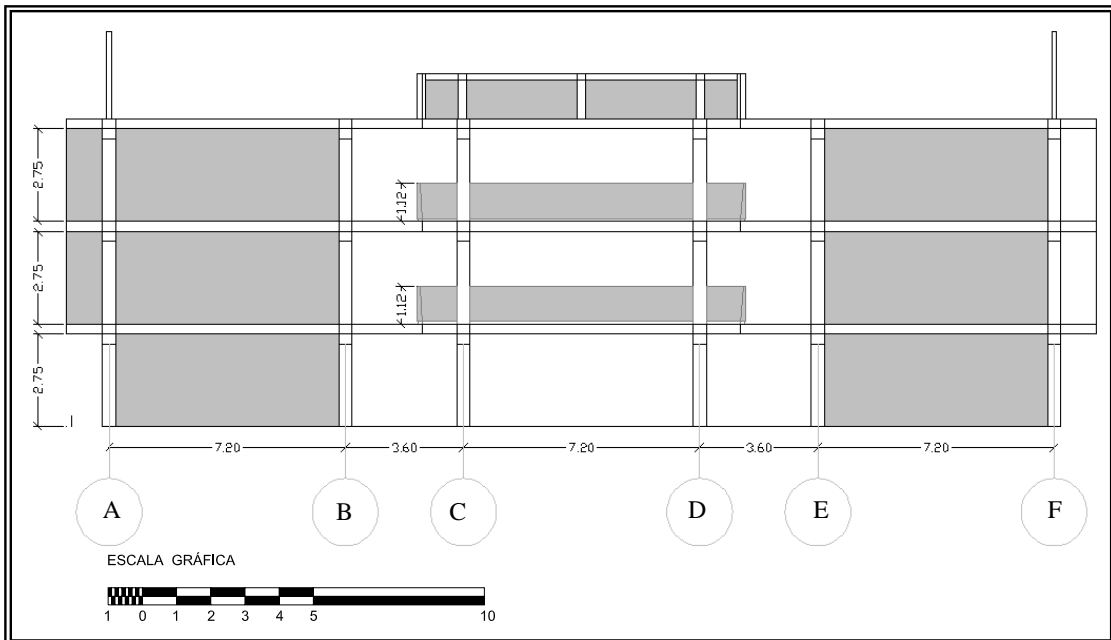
Pórtico 5 (norte-sur) mostrando las paredes de mampostería y la longitud efectiva de columnas
